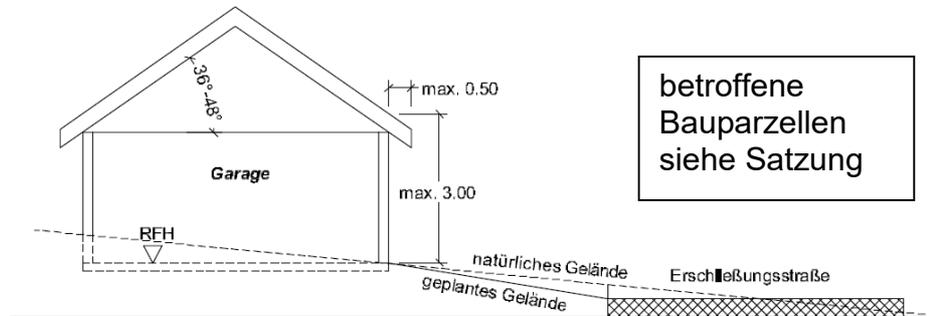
Lage des Baugeländes (Garage) höher als Erschließungsstraße – Erläuterungsskizze zur Punkt 2.2.2 a) der Satzung
